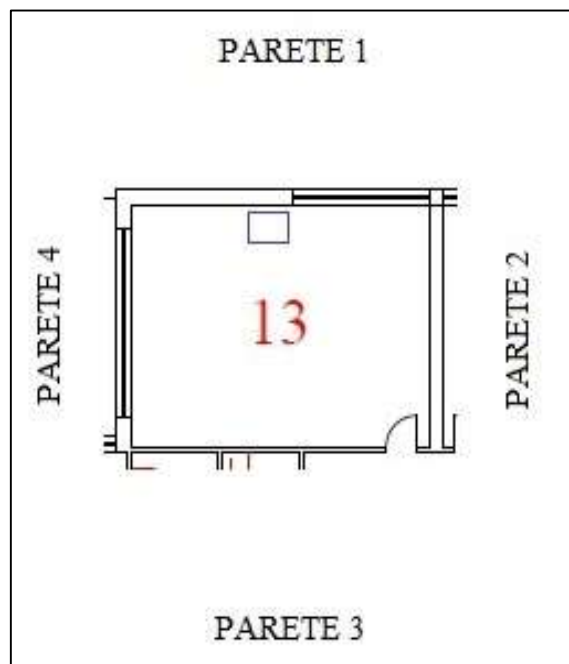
Planimetria dell’Aula 13 (Biblioteca) oggetto di misurazioni
